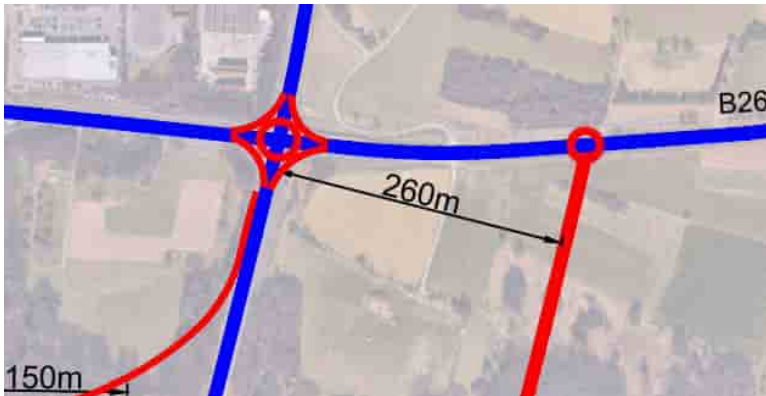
K1 – Stachusknotten als einstreifiger Kreisverkehr mit vier Bypässen – Planfall 6b
